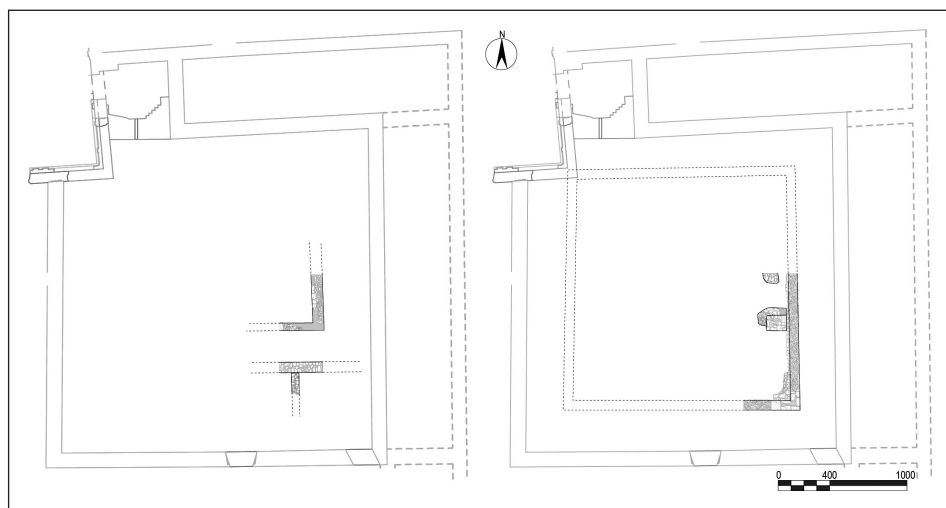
Claustro de la hospedería: imagen izquierda situación de las estructuras de la Fase I; imagen derecha, estructuras de la galería del claustro (Fase II) con proyección hipotética de su trazado.
